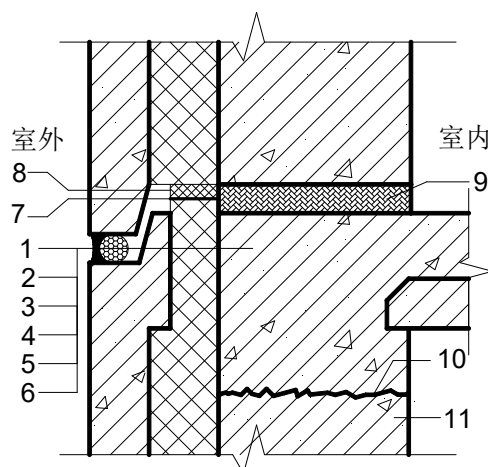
预制混凝土夹心保温墙板水平缝密封防水构造
